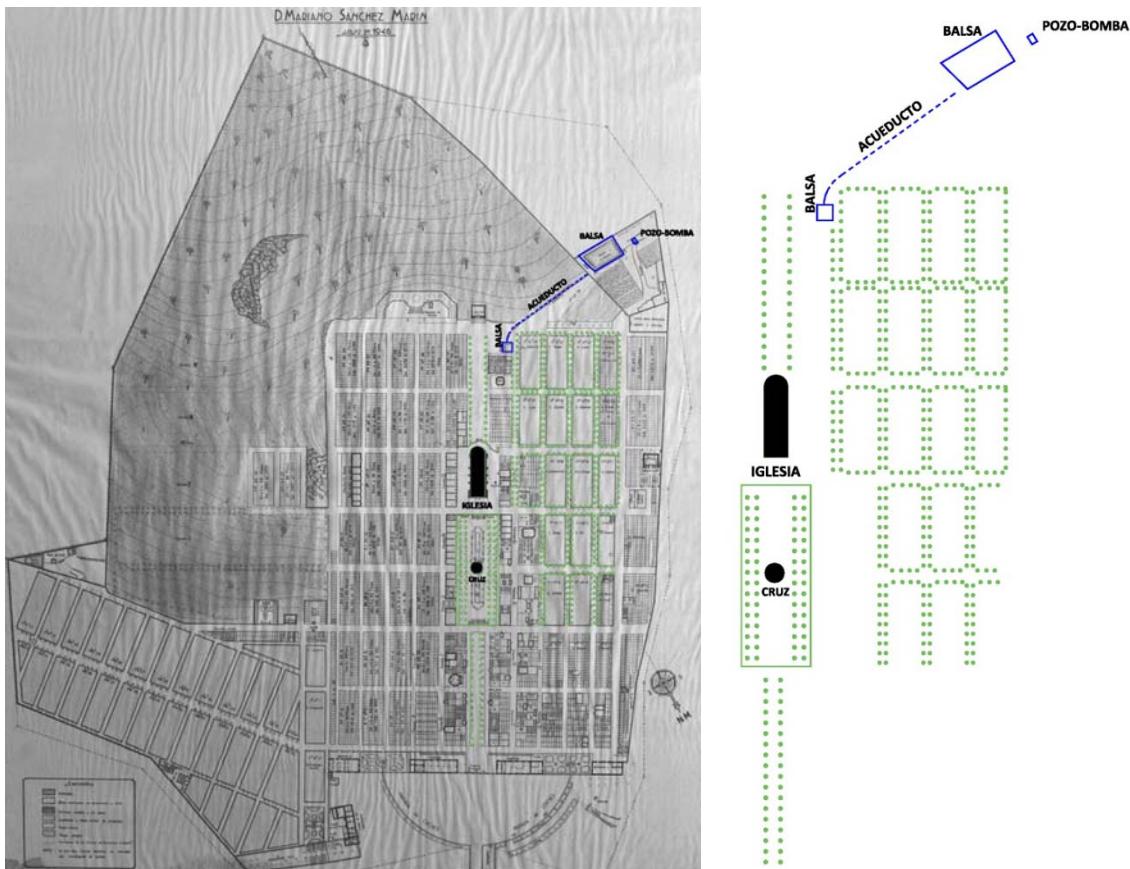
Izquierda,plano de 1946 expuesto en la oficina del cementerio. Derecha, esquema de sistema de riego. Elaboración propia
